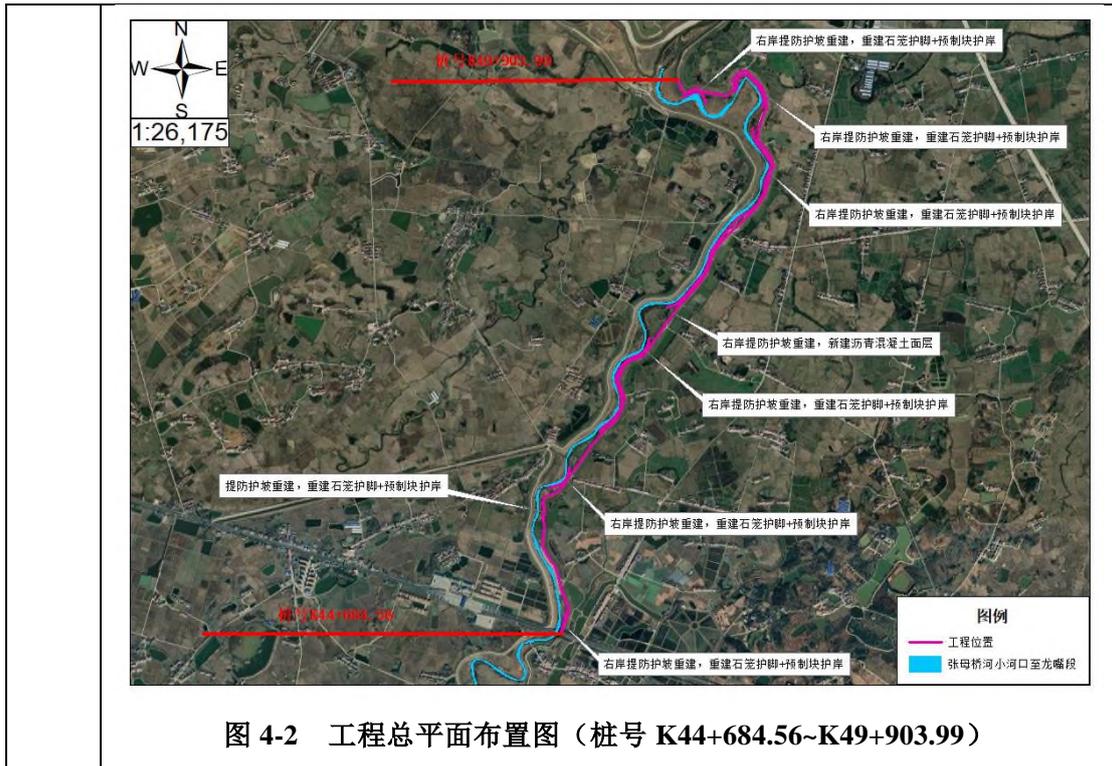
工程总平面布置图（桩号 K44+684.56~K49+903.99）
